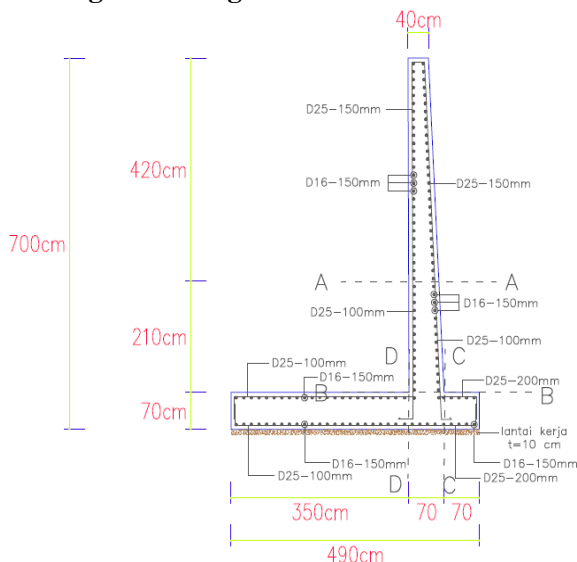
Detail Dimensi Penampang Dinding Penahan Tanah Kantilever
